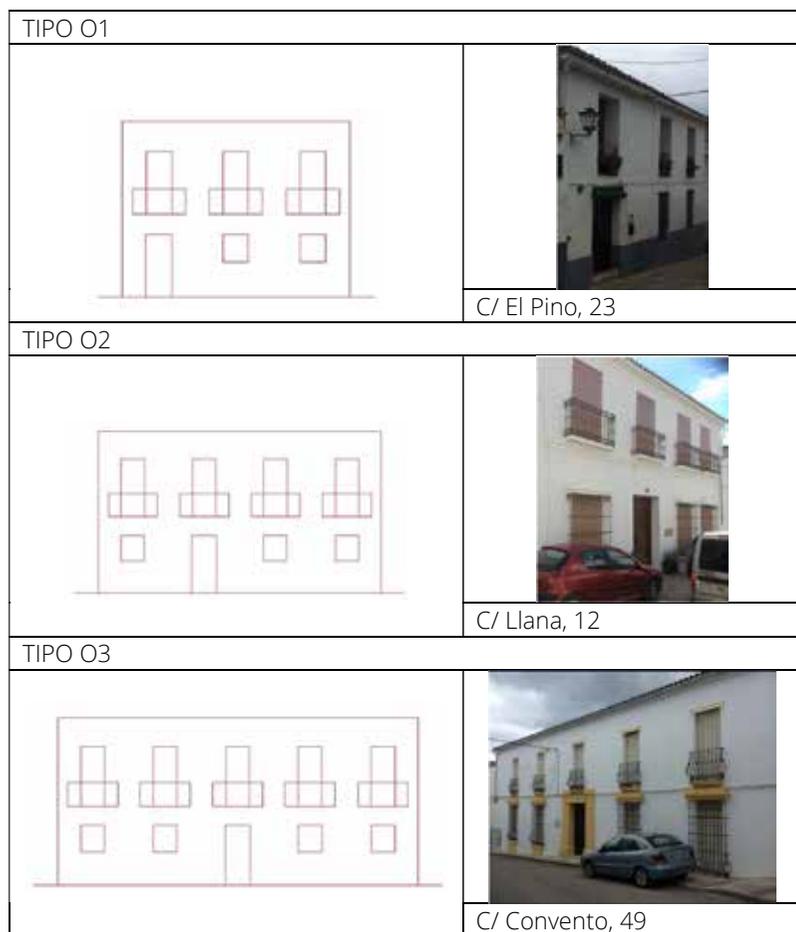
Tipos de fachada del grupo 3 (2 plantas con balcón). Fuente de Autor.
